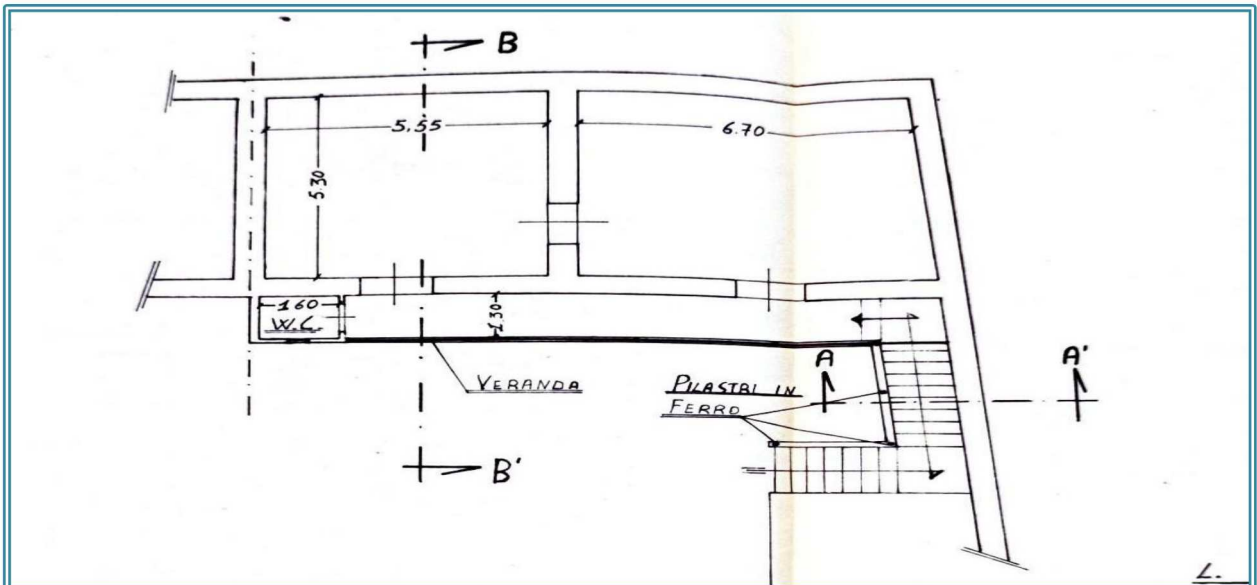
Pianta piano primo (post operam) – estratto dal fascicolo pratica di costruzione edile n. 5951 del 17.03.1988
